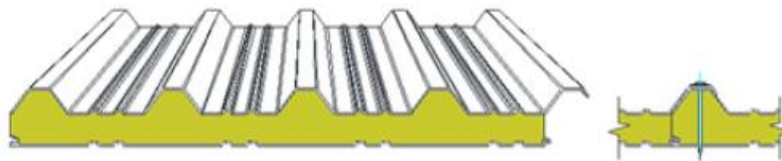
Panel Sándwich (Fuente PoliformaT – Tecnología de la Construcción).
